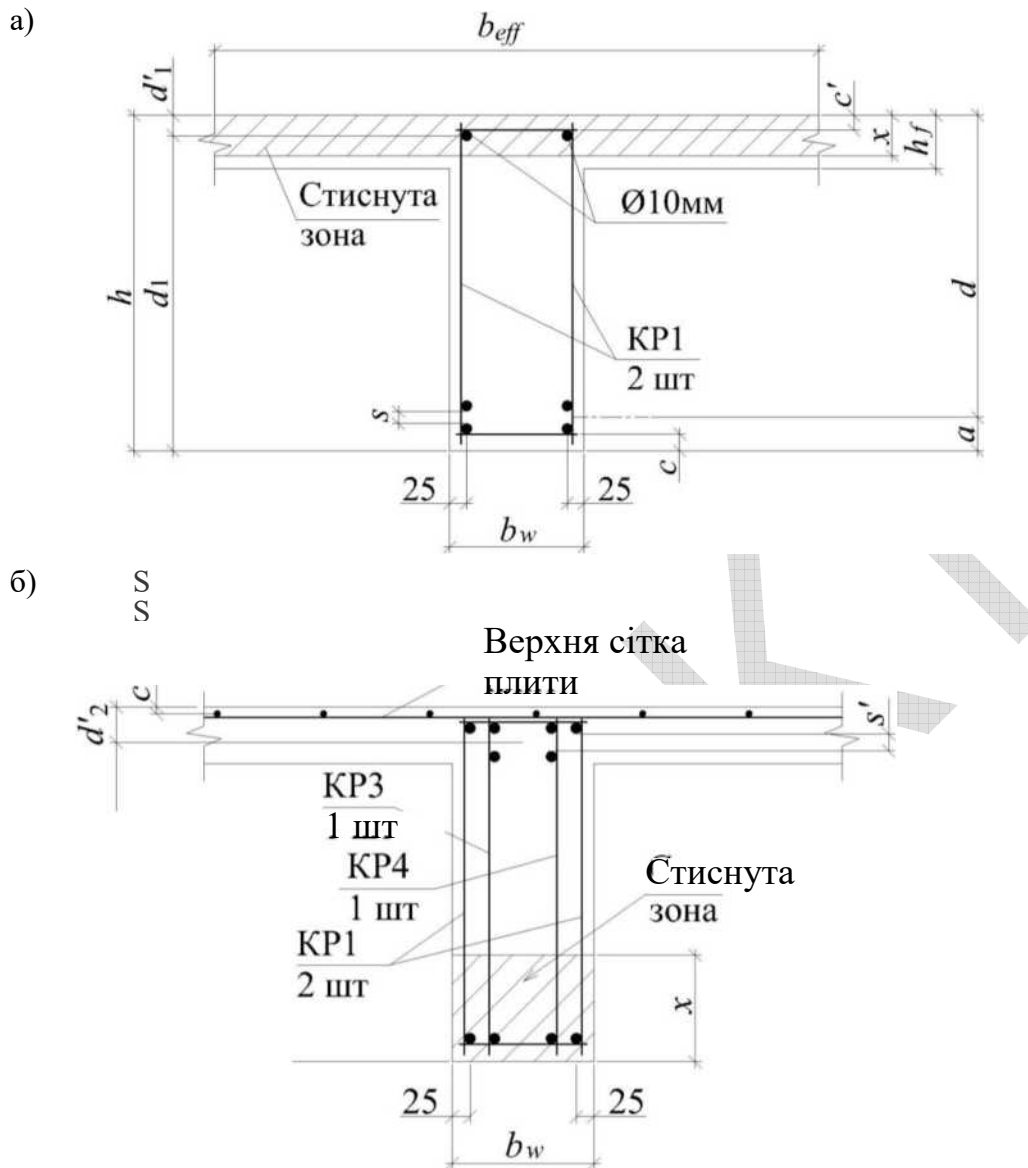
Компонівка перерізів другорядної балки: а) у прольоті; б) на опорі
